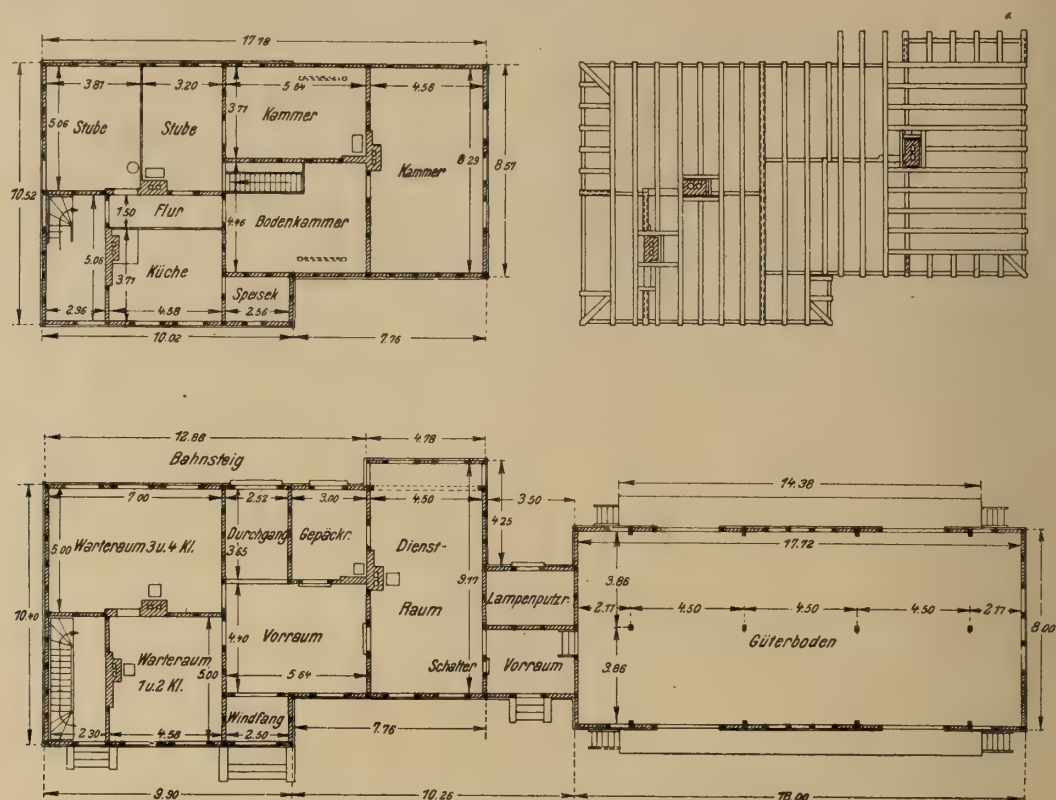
Grundrisse für Empfangsgebäude Clausthal-Ost
